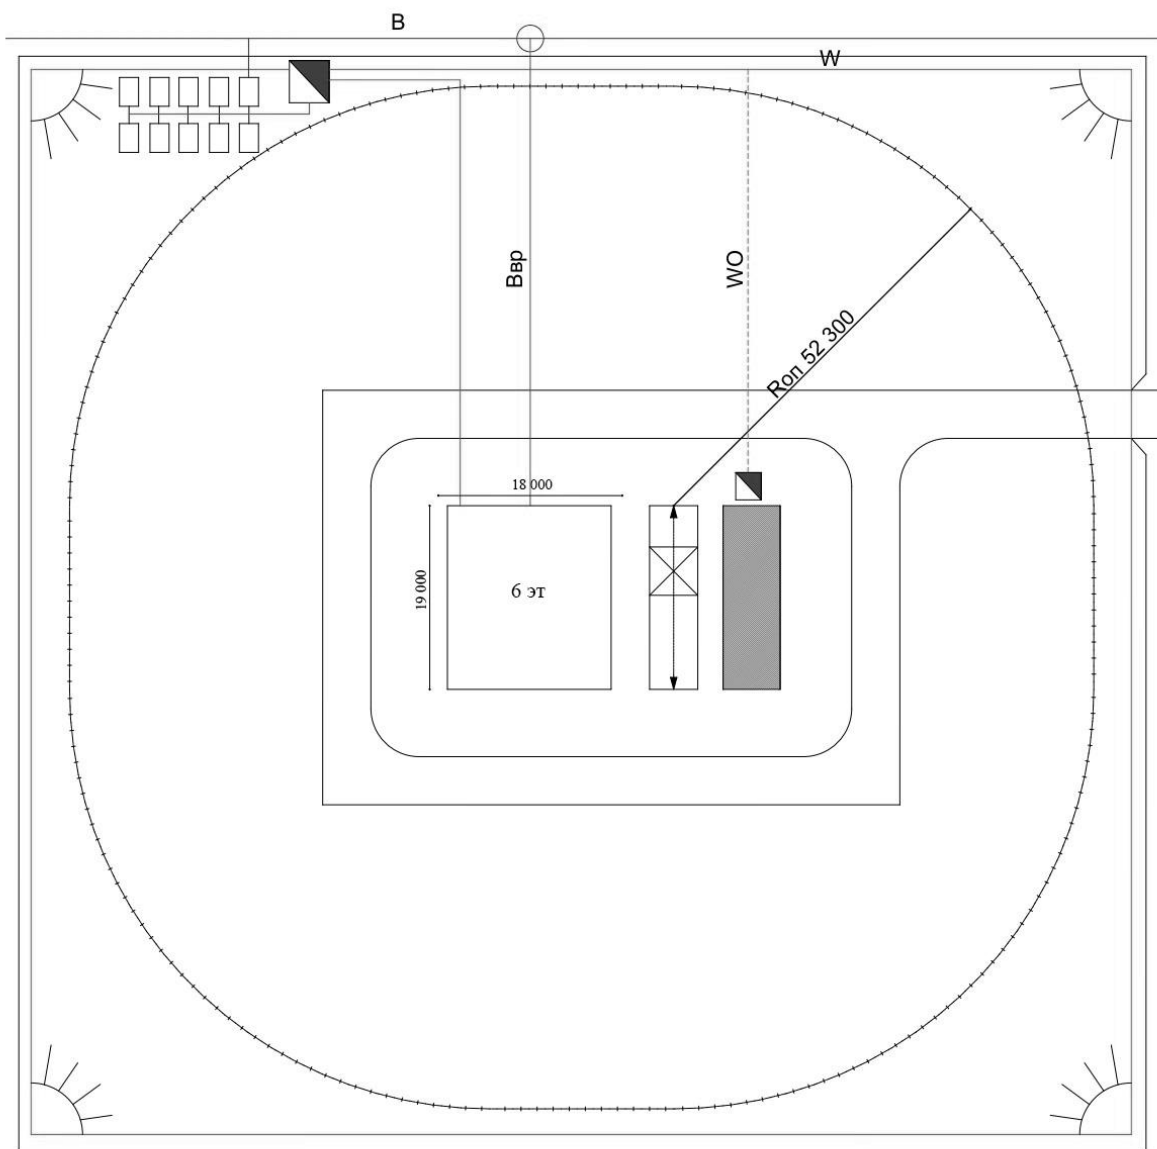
Общеплощадочный стройгенплан на строительство жилого здания.
